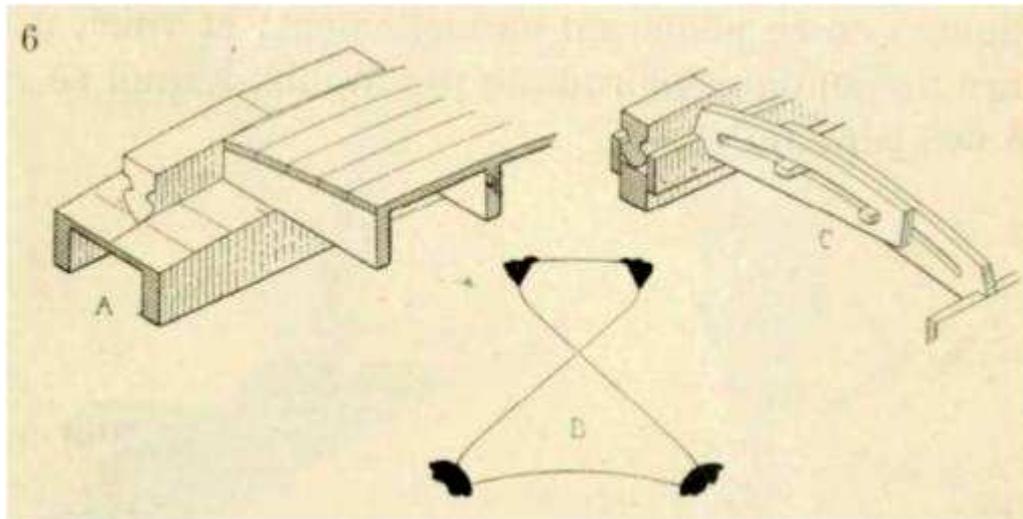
13.3 Tablero y cercha móvil de Viollet-Le-Duc para las plementerías, según Choisy.
